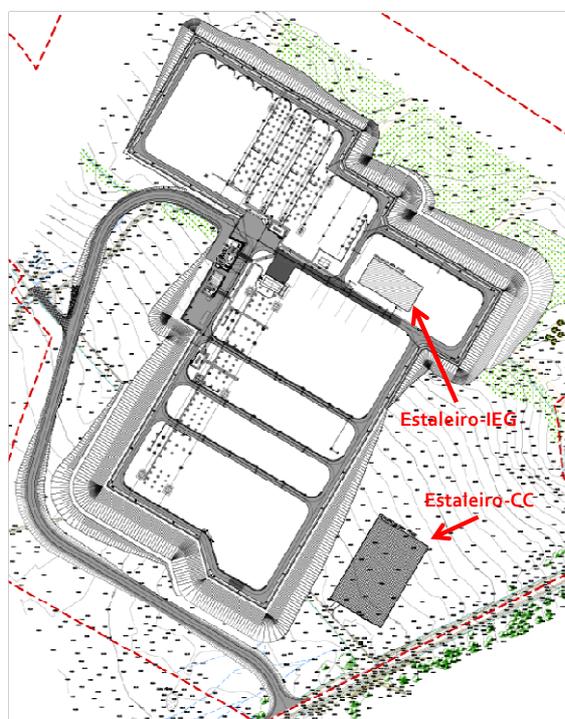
Estaleiro de Construção Civil da Subestação – Localização e Principais Instalações
